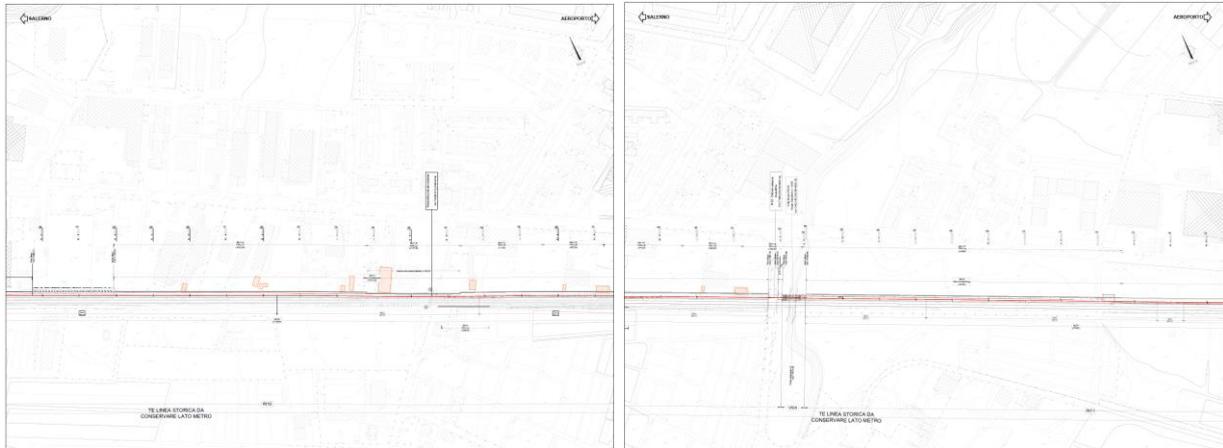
Stralcio della planimetria di progetto dal km 7+800 al km 9+055
